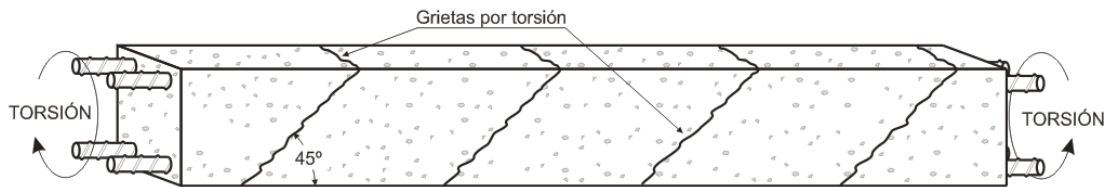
Patrón de grietas por torsión en una viga prismática.
